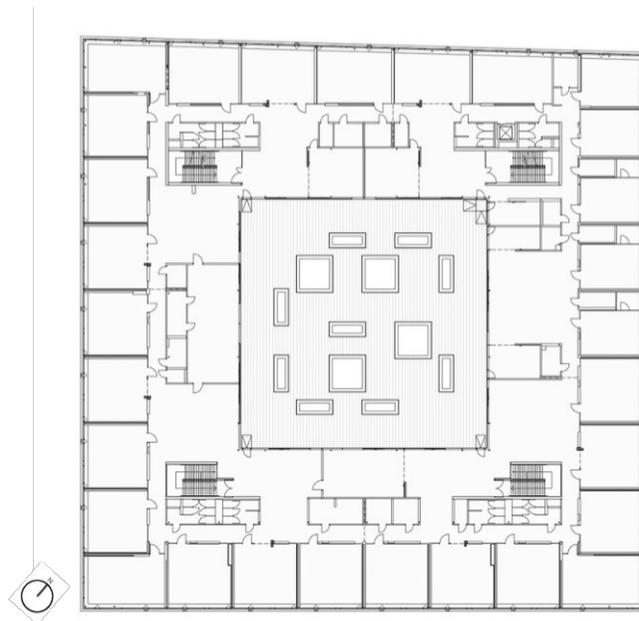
Grundriss, 2. Obergeschoss, Gruppierung von Klassenräumen um zentralen Marktplätze
